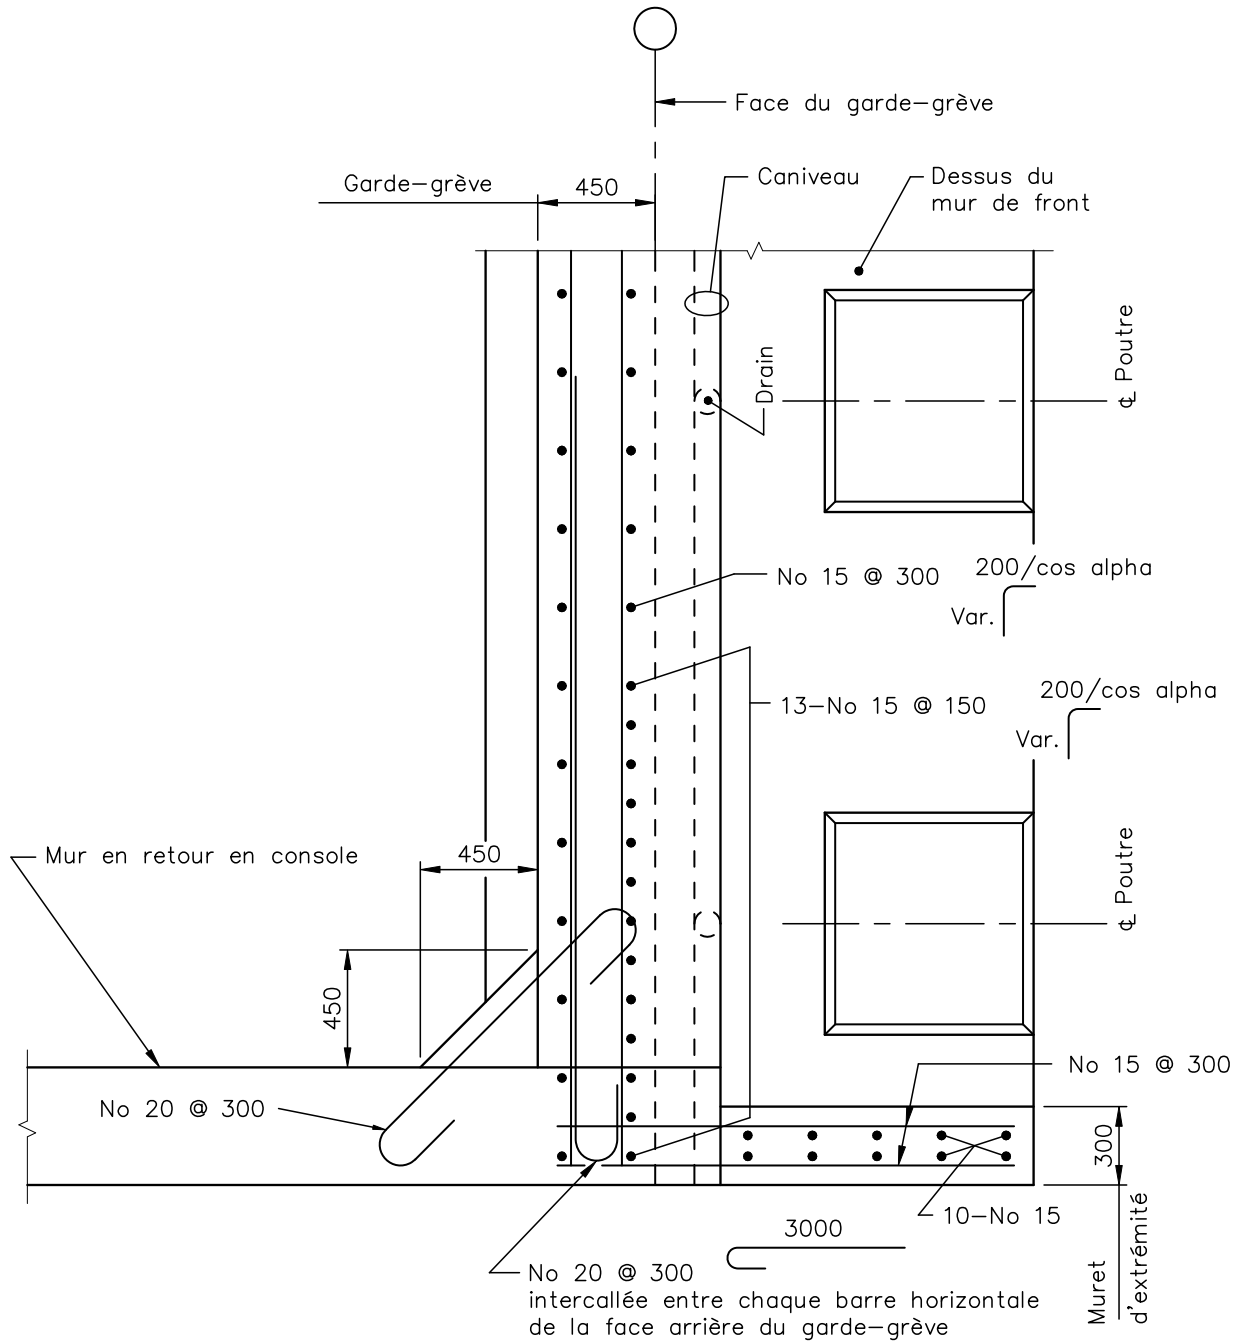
Culée-galerie avec joint de tablier (armature)
